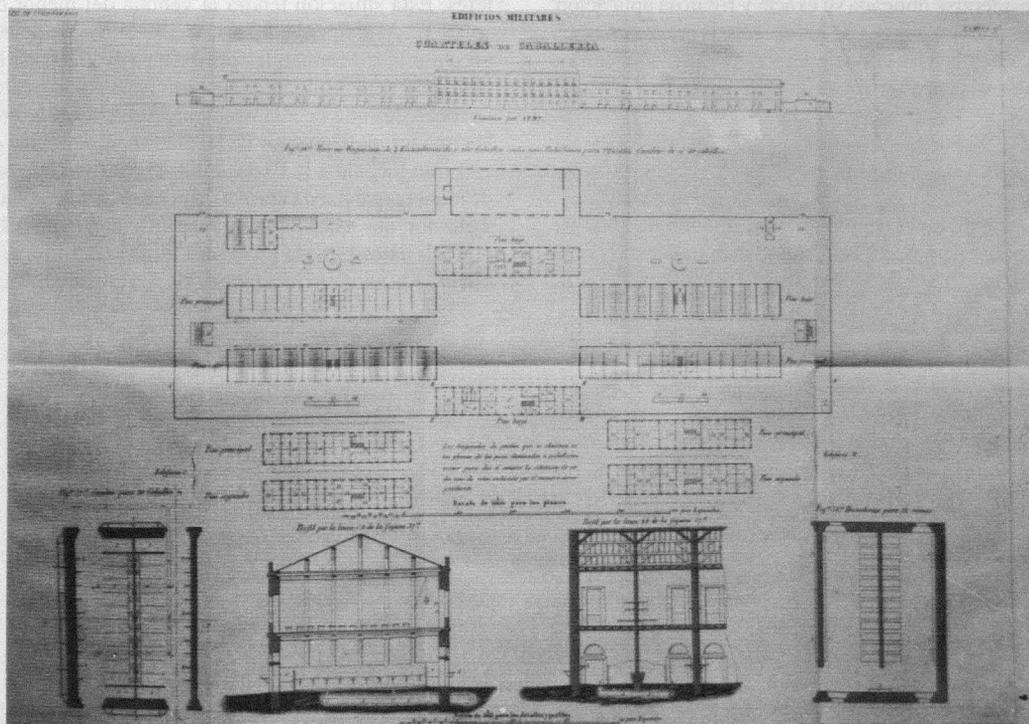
Cuarteles de Caballería: disposición con fachadas mayores o estribos de pabellones en dirección al patio central, secciones y plantas de cuadra y habitación. (Memorial de Ingenieros, 1848, Lám. 9).
